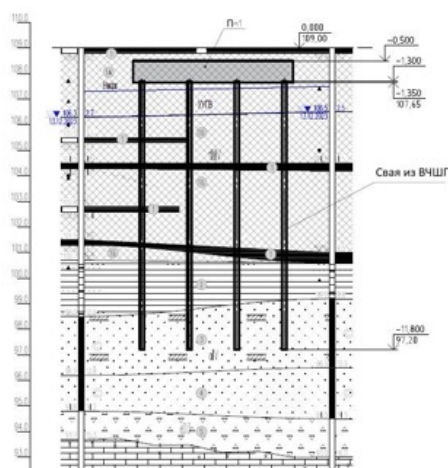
Инженерно-геологический разрез под свайный фундамент под оборудование. Условные обозначения: Пм-1 – фундамент под оборудование, ИГЭ 1,1Б – насыпные грунты, ИГЭ 2 – глина полутвердая, ИГЭ 3,4 – песок средней крупности, средней плотности, ИГЭ 5 – щебенистый грунт, ИГЭ 6 – известняк. План свай приведен на рис. 17.
